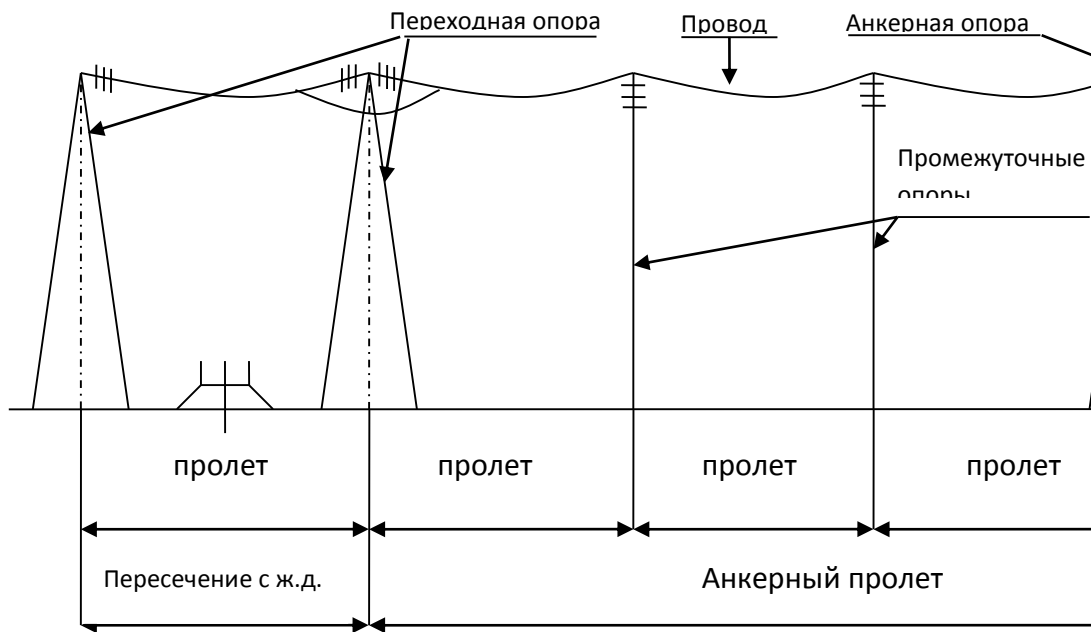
Схема анкерного пролета ВЛ и пролета пересечения с железной дорогой.
